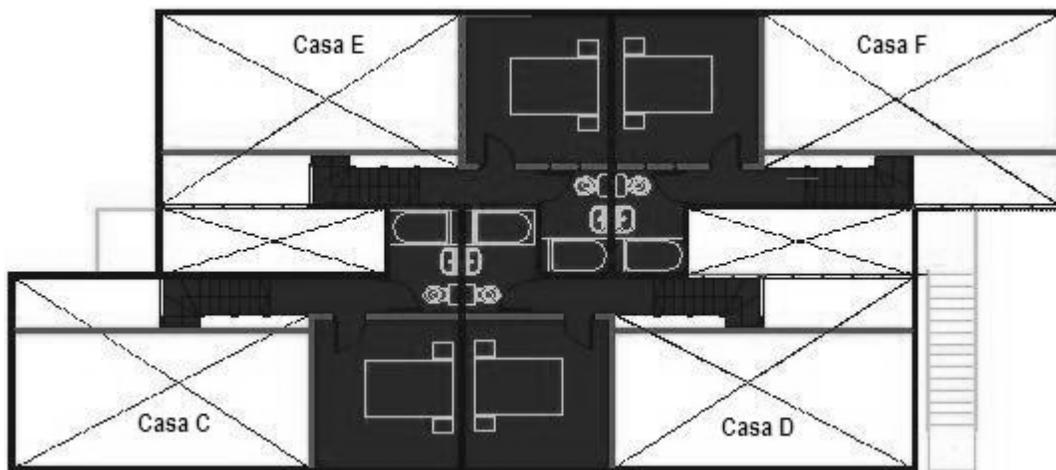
Planta Casa C, D, E, F, tercer nivel. Zona achurada superficie inicial.
